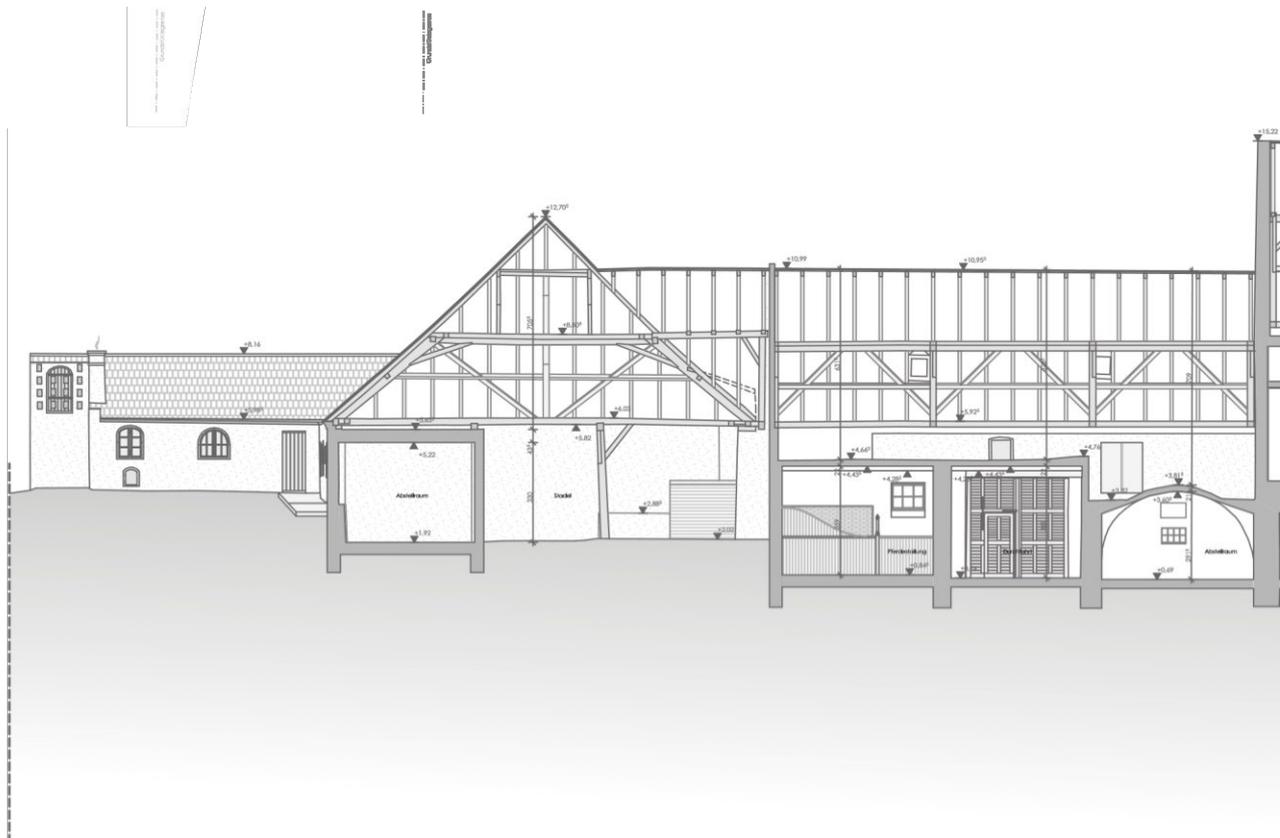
Bestandsplan Schnitt 1-1 M 1:250
